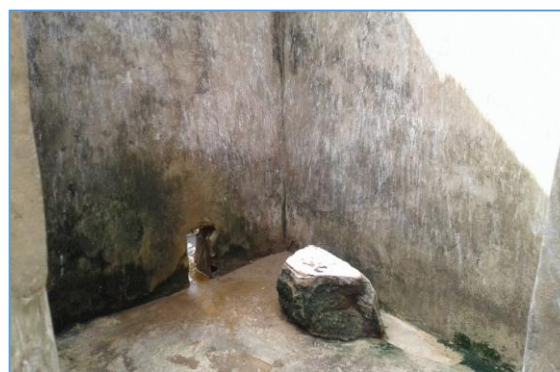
Latrine traditionnelle - Salle d'eau (SDE)
